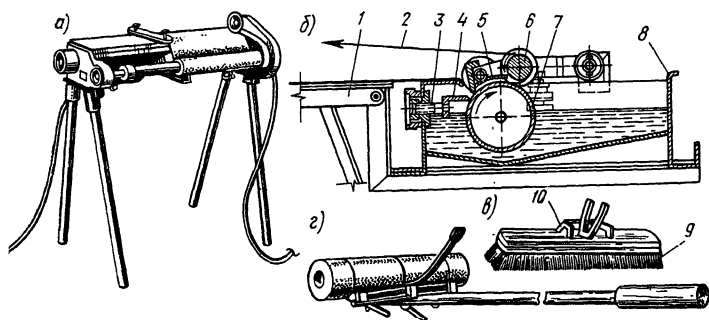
Механизмы и приспособления для подготовки и наклейки обоев
